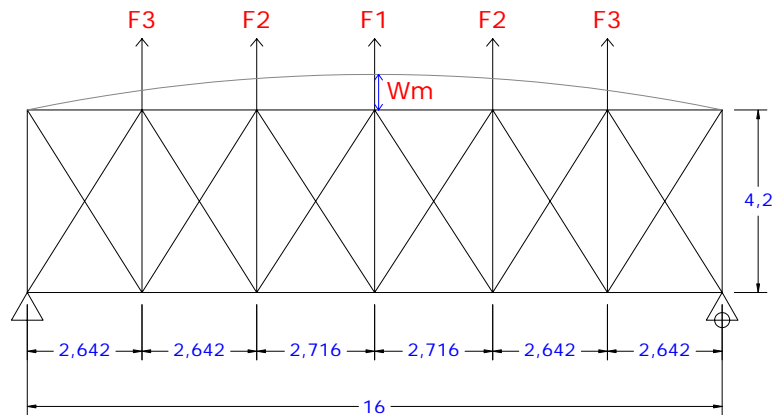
Tampak Atas Pemodelan Ikatan Angin
